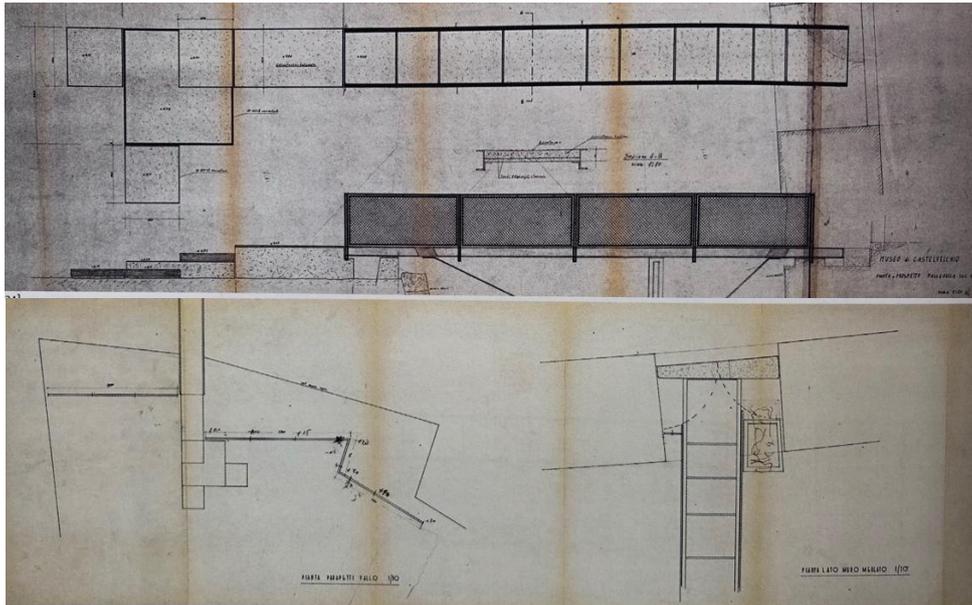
Planta baixa, vista e detalhamento de Scarpa para a nova ponte metálica do fosso interno
